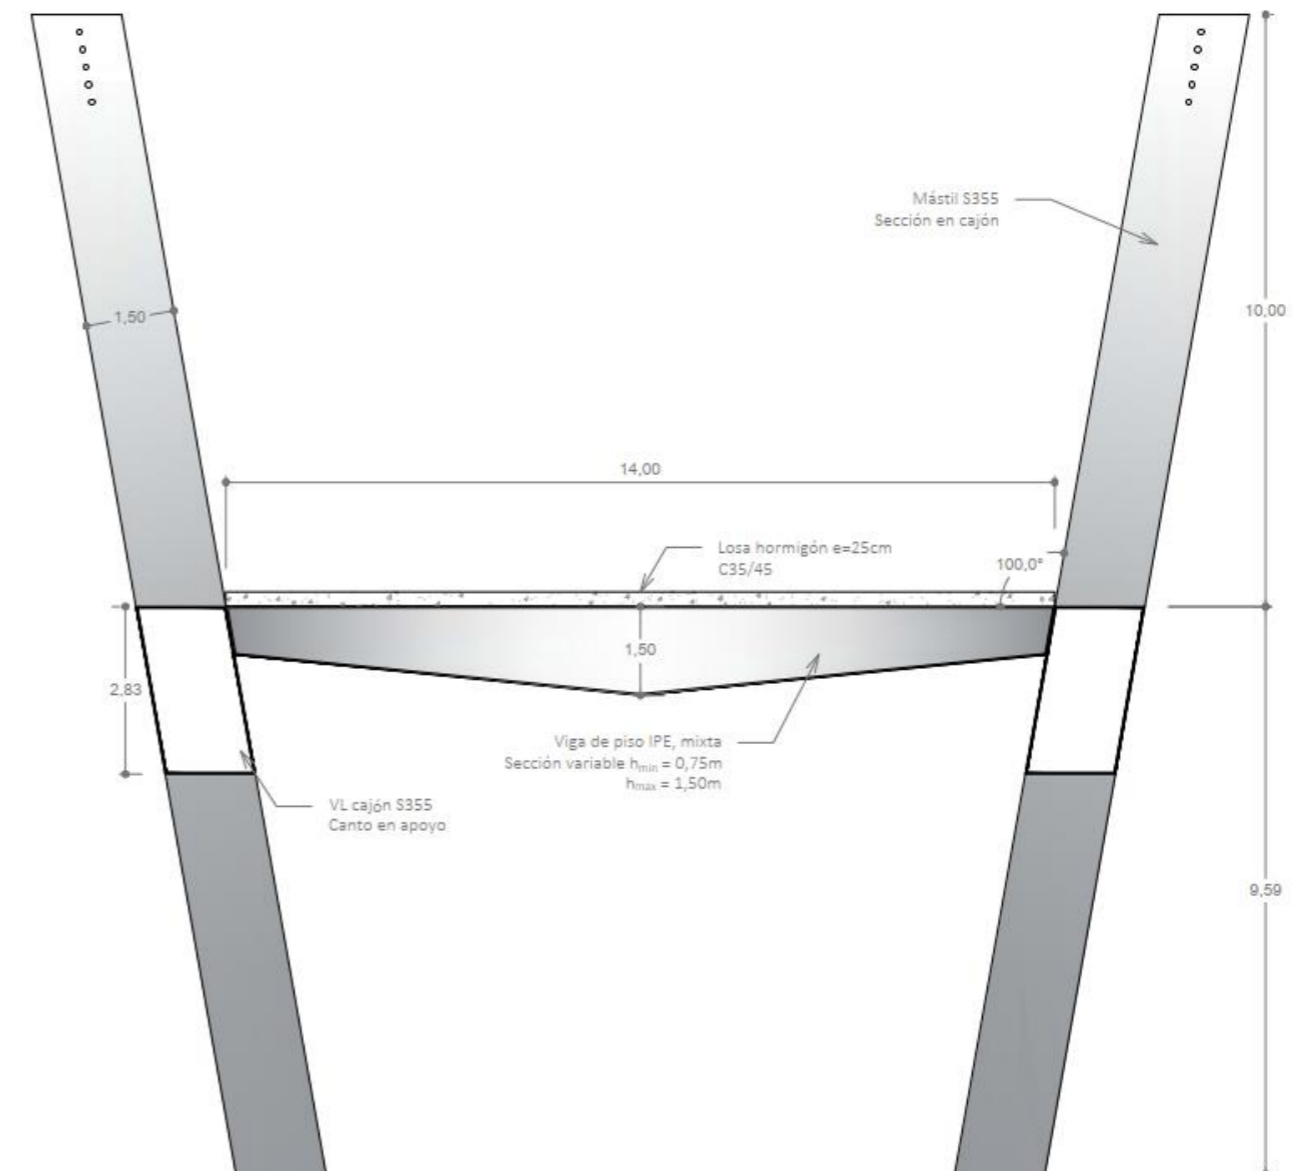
Sección transversal alternativa 3 puente atirantado (fuente: elaboración propia)
